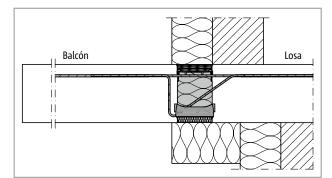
Schöck Isokorb® XT tipo K: Conexión para losa apoyada indirectamente y SATE
